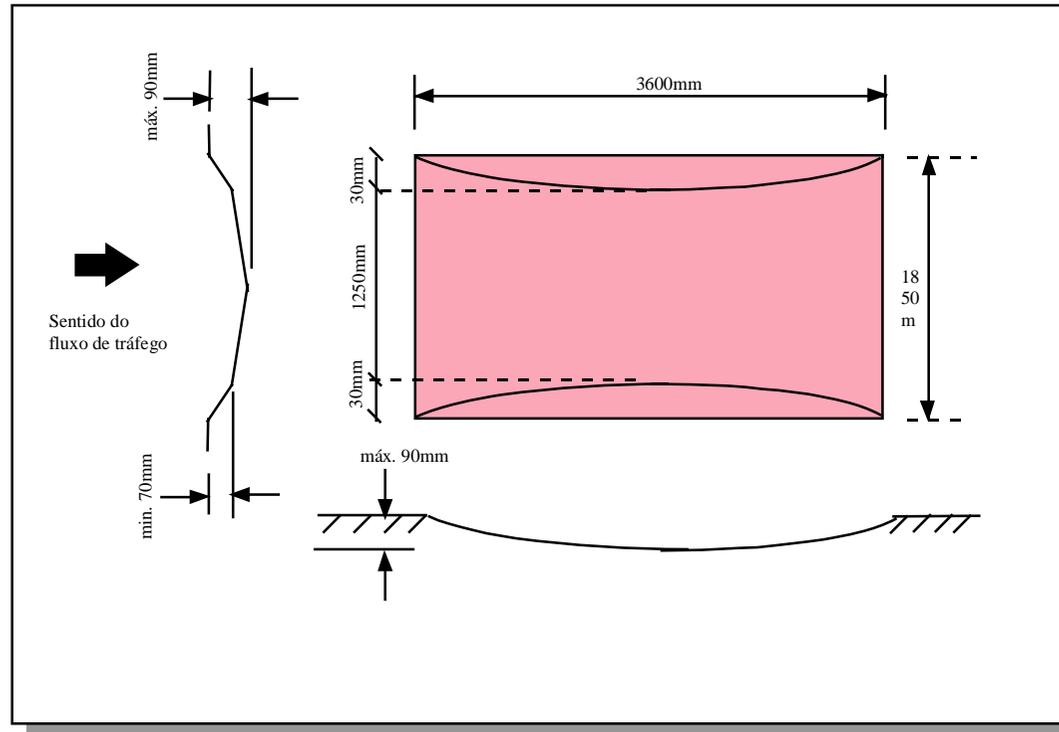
Detalhamento da depressão com perfil circular e trapezoidal
